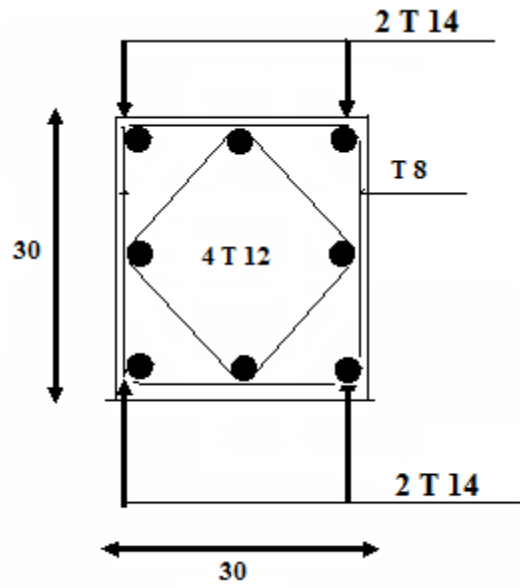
coupe de ferrailage des poteaux 30x30 cm²
